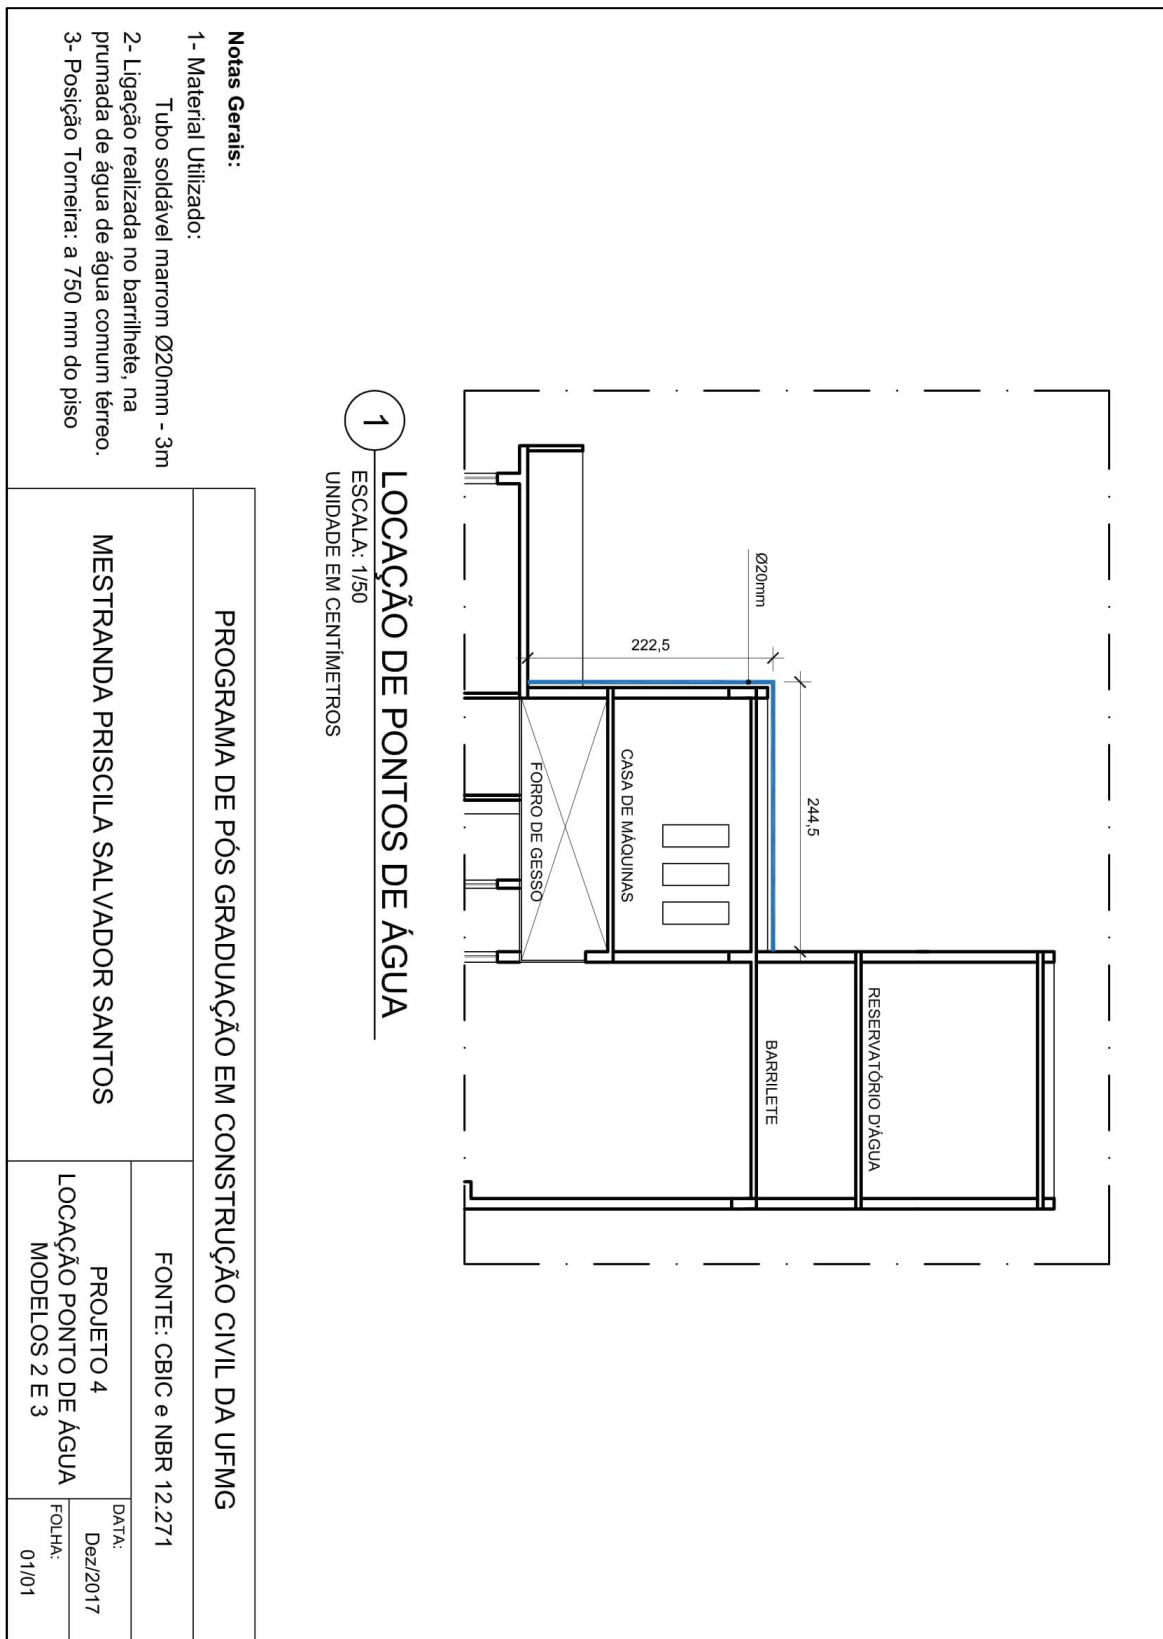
Planta localização Ponto de água Projeto 3 do Modelo 2
